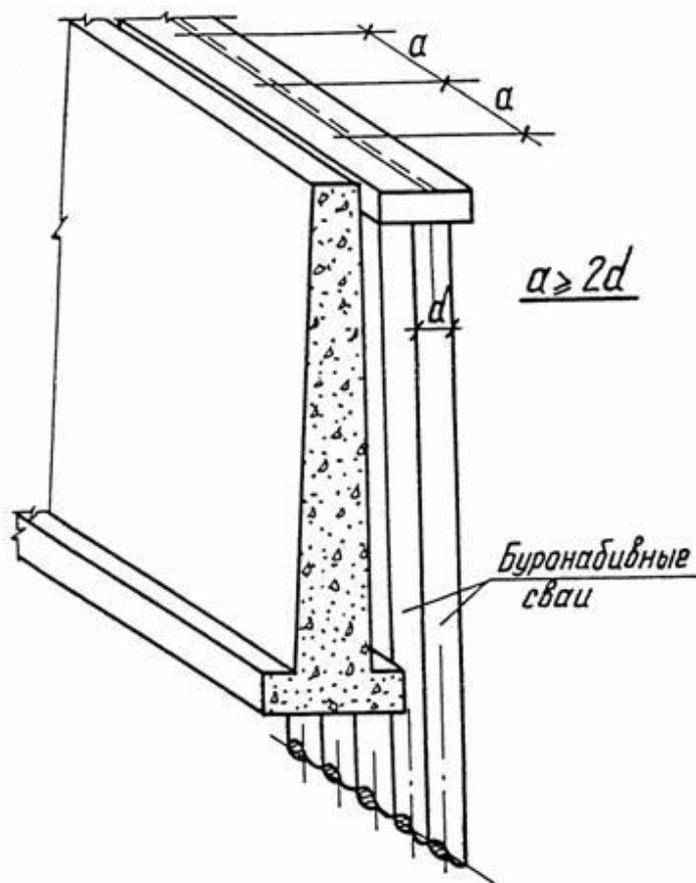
Усиление подпорных стен в стесненных условиях генплана с помощью буронабивных свай
